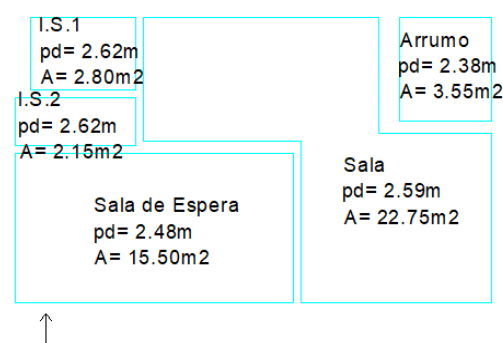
Planta da fracção com a delimitação das envolventes e planta de áreas (Caso 5 - sem escala)
